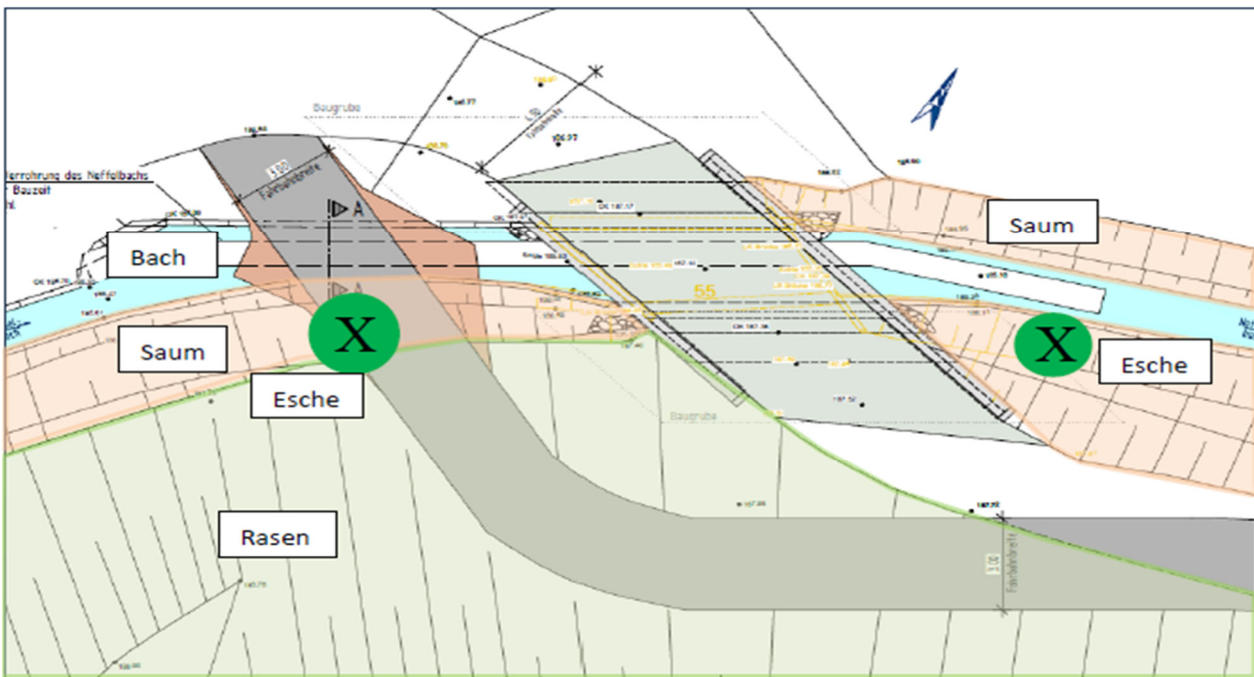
Lageplan zur Errichtung der Brücke, inkl. Ersatzbrücke, Verrohrung und den betroffenen Biotoypen
